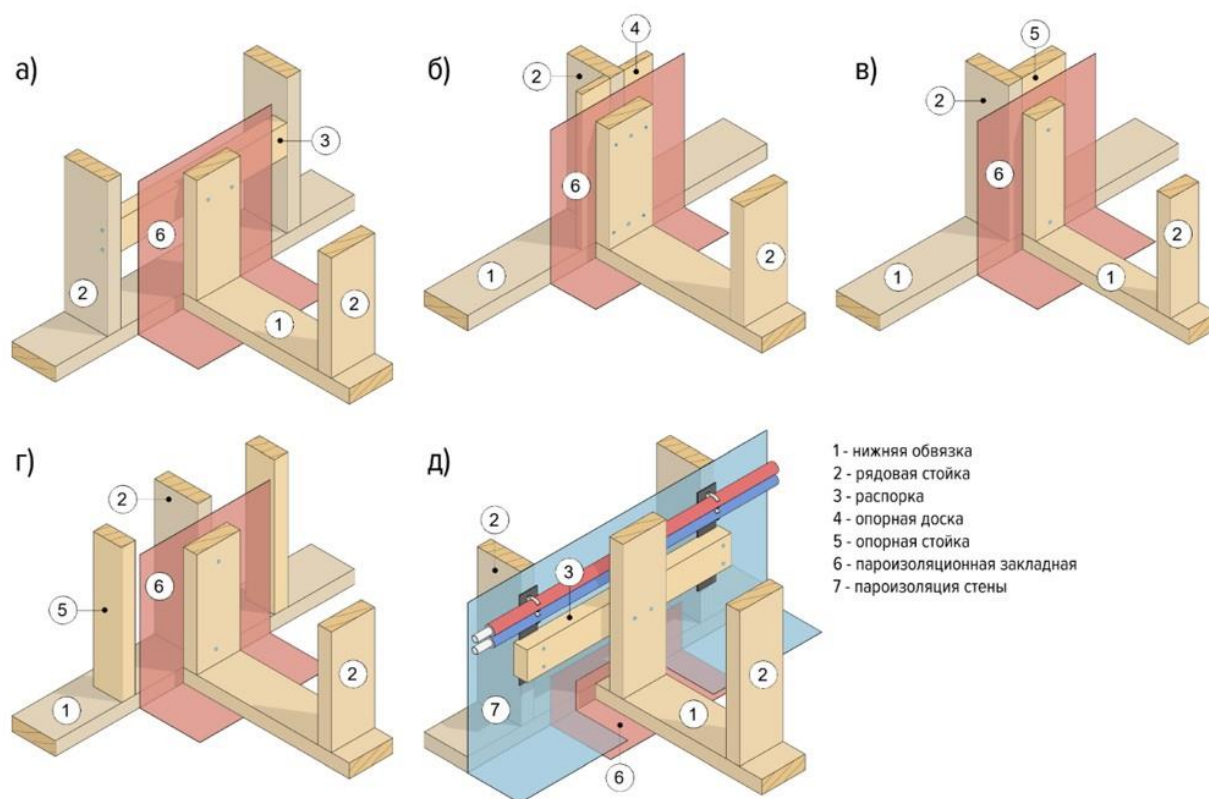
Варианты примыкания внутренних стен к наружной
